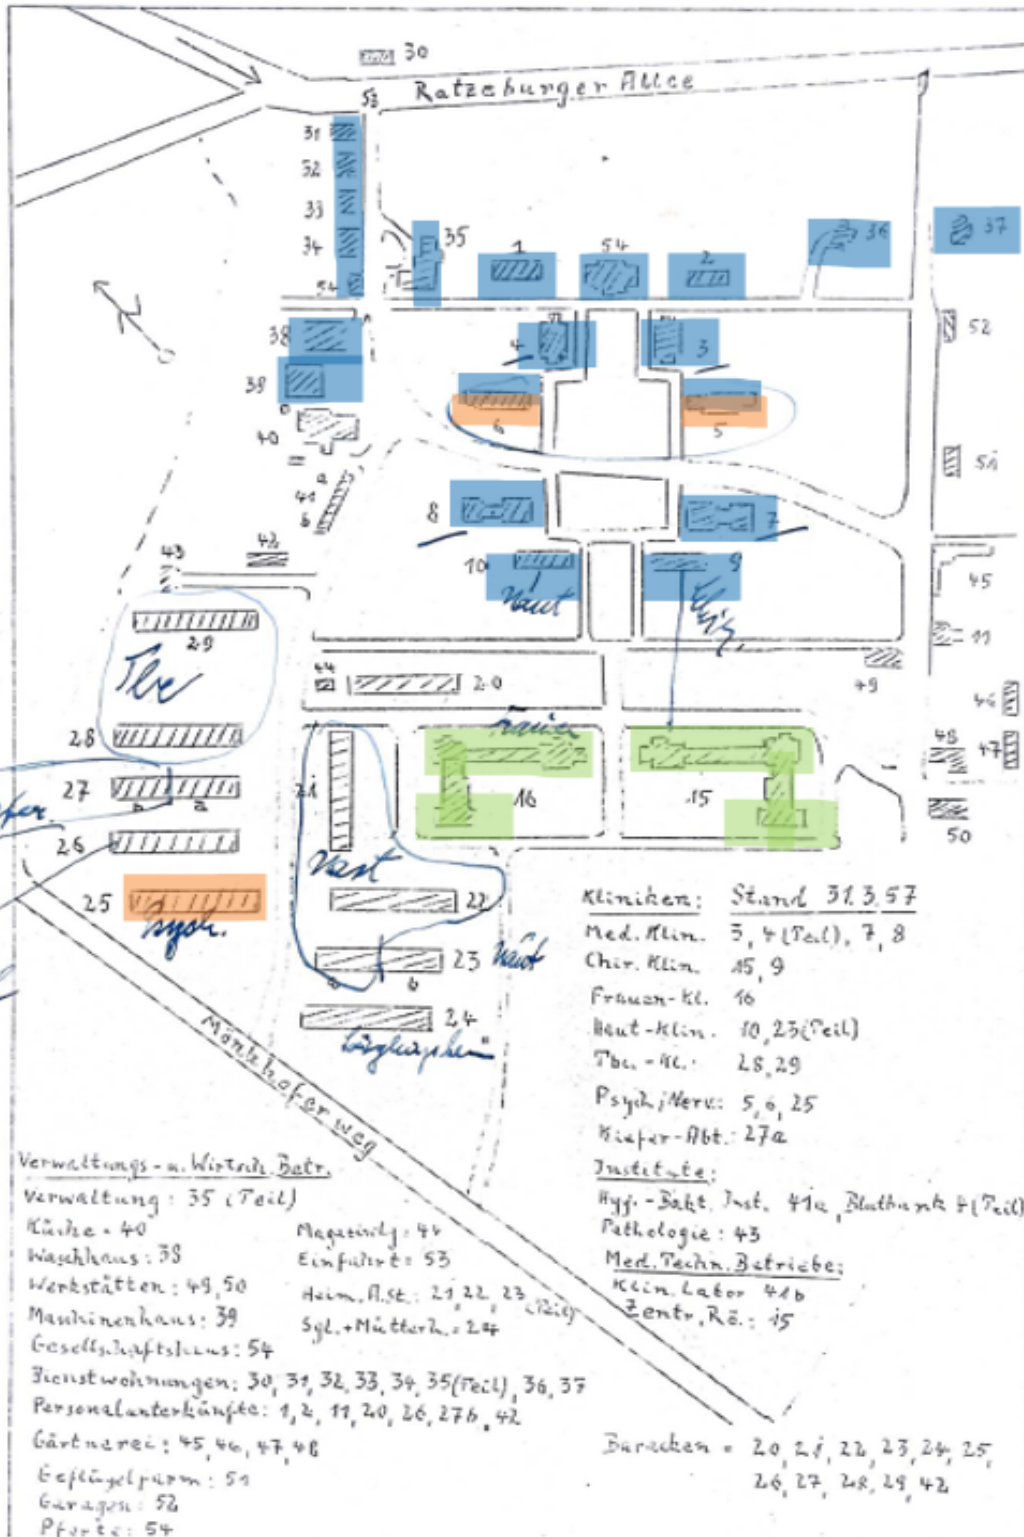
Lageplan des städt. Krankenhauses Ost, undatiert
